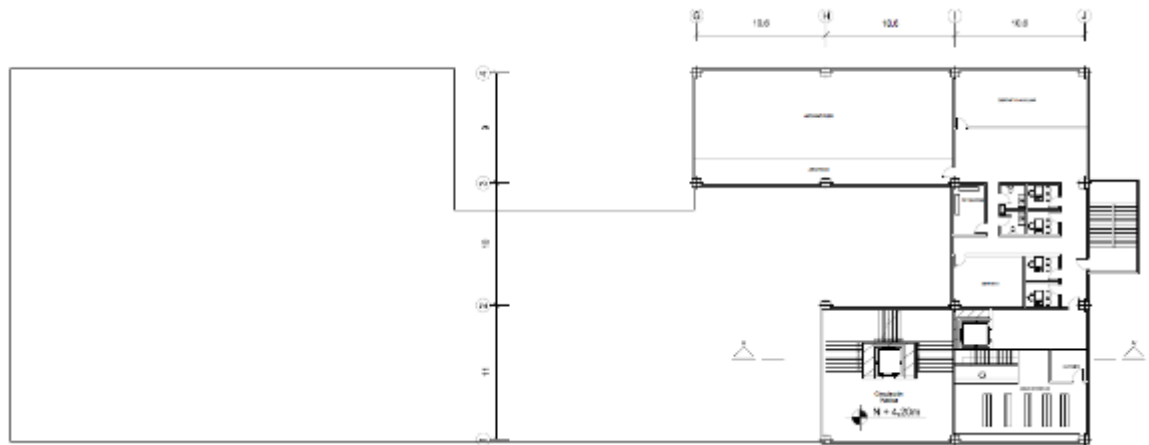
Planta Mezzanina Nivel +4.20. (2018).
